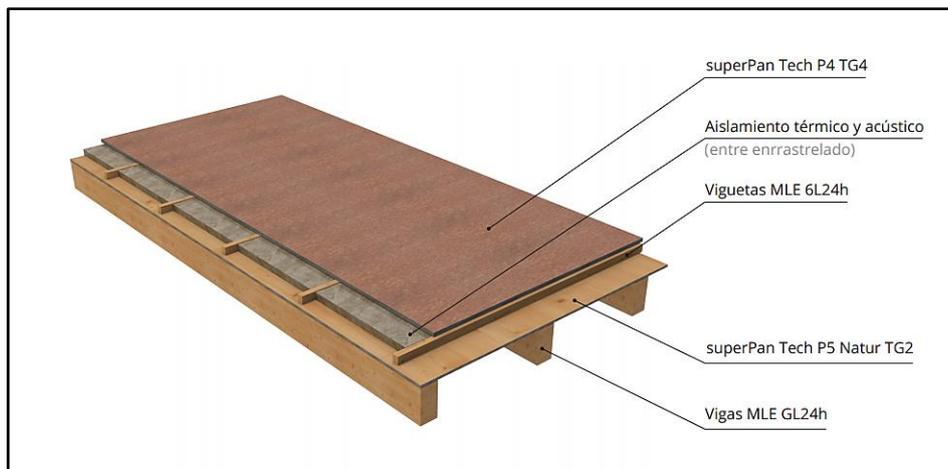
Forjado de madera con vigas vistas.<sup>102</sup>
